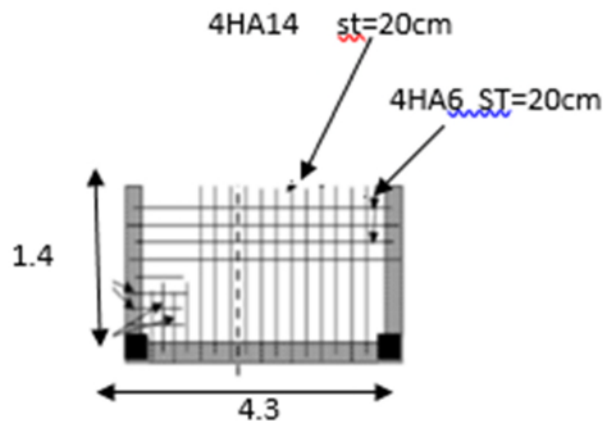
Schéma de ferrailage de balcon sur 2 appuis
